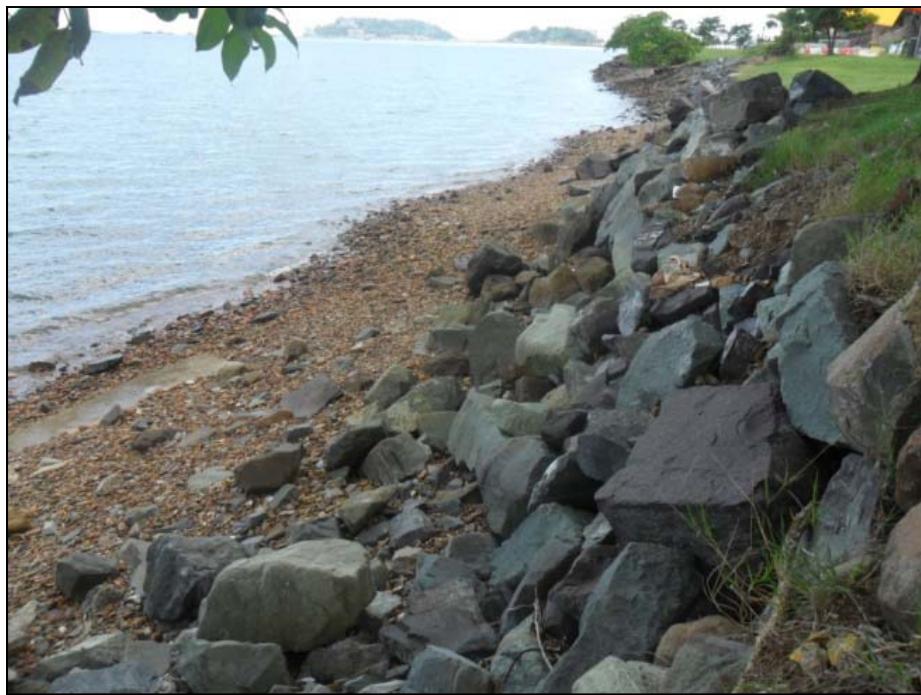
Vista de relleno empedrado de la costa en Amador
